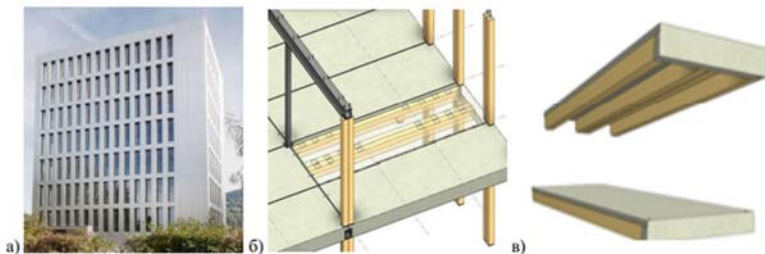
8-ми этажное офисное здание Life Cycle Tower (г. Дорбирн, Австрия): а) общий вид здания, б) часть конструктивной системы; в) ребристая деревобетонная плита перекрытия
